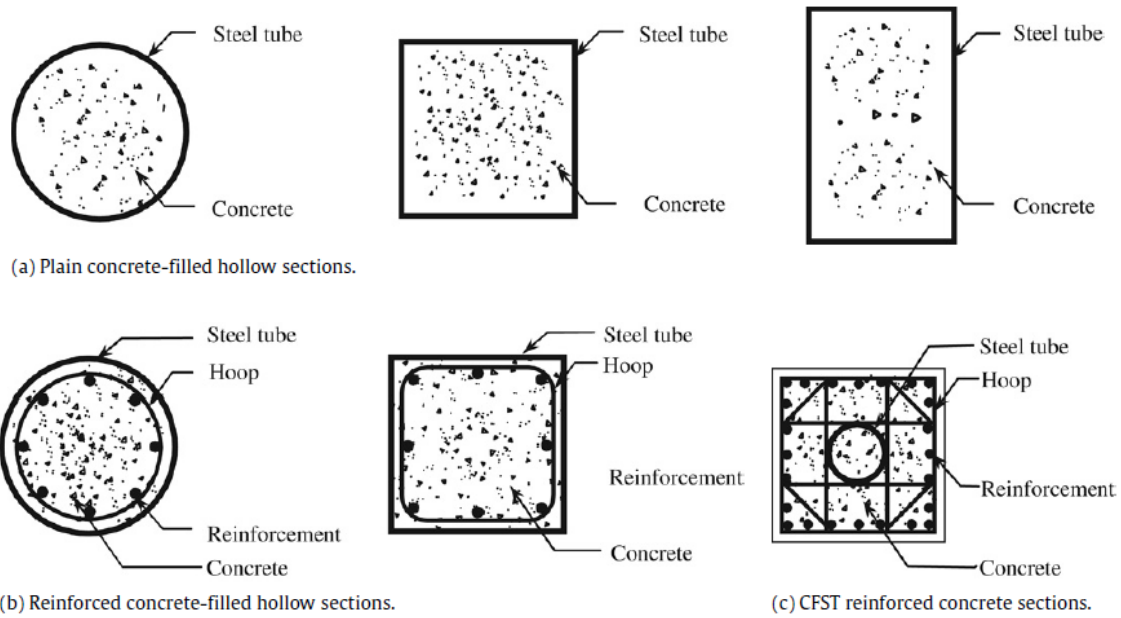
(a) Secciones huecas en acero rellenas de concreto, (b) Secciones reforzadas rellenas de concreto, (c) Secciones tipo CFST reforzadas rellenas de concreto. Fuente: Tomado de referencias (Yang, Lam, & Gardner, 2008), Pág. 3773.
